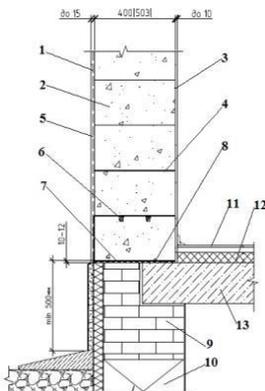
Стена из ячеистобетонных блоков (ЯБ): 1 – штукатурный слой; 2 – ЯБ; 3 – внутренняя отделка; 4 – кладочный раствор; 5 – грунтовочный слой; 6 – металлический стержень; 7 – выравнивающий слой цементно-песчаного раствора; 8 – гидроизоляция (заходят на первый ряд блоков); 9 – кирпичная кладка фундамента; 10 – железобетонное основание; 11 – конструкция пола; 12 – теплоизоляция; 13 – плита перекрытия
